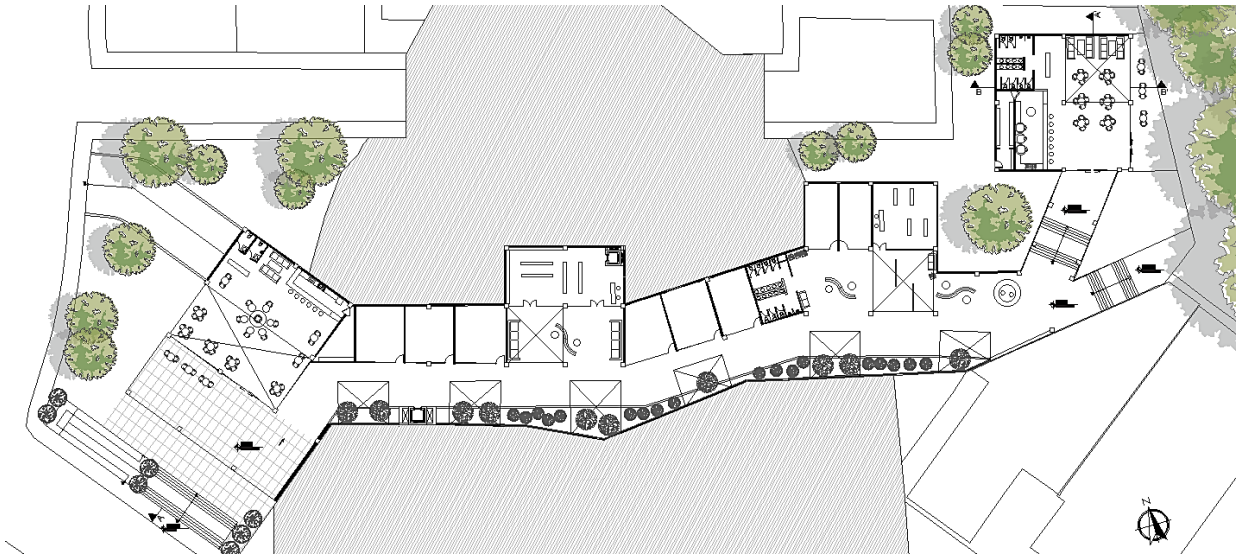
Planta Subsuelo 1 – área comercial. Elaboración propia.
